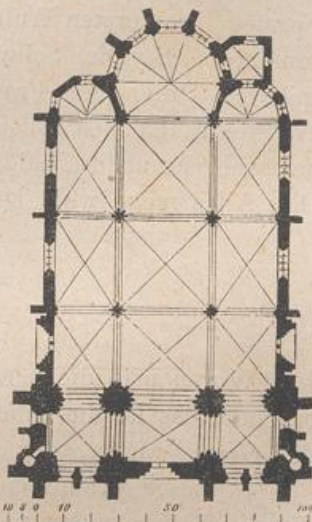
Grundriss der Wiesenkirche zu Soest.
